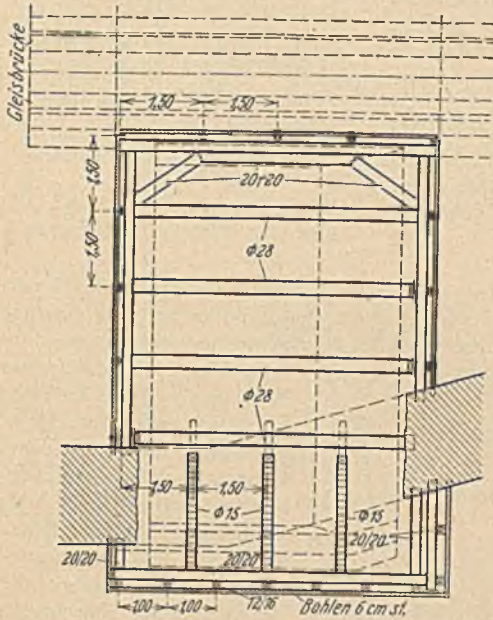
Grundriß des westlichen Widerlagers mit Baugrubenaussteifung.
